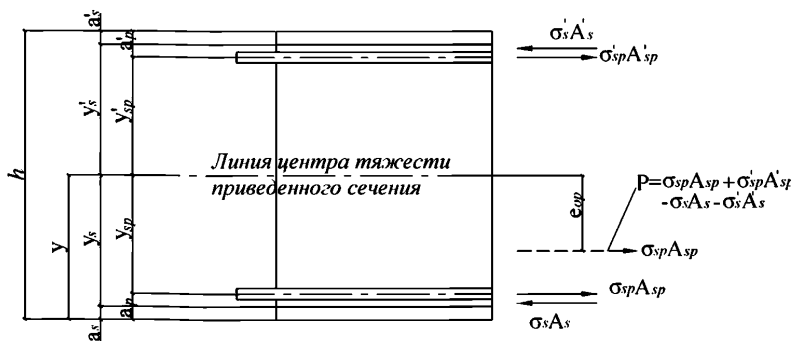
Схема усилий предварительного напряжения арматуры в поперечном сечении железобетонного элемента
